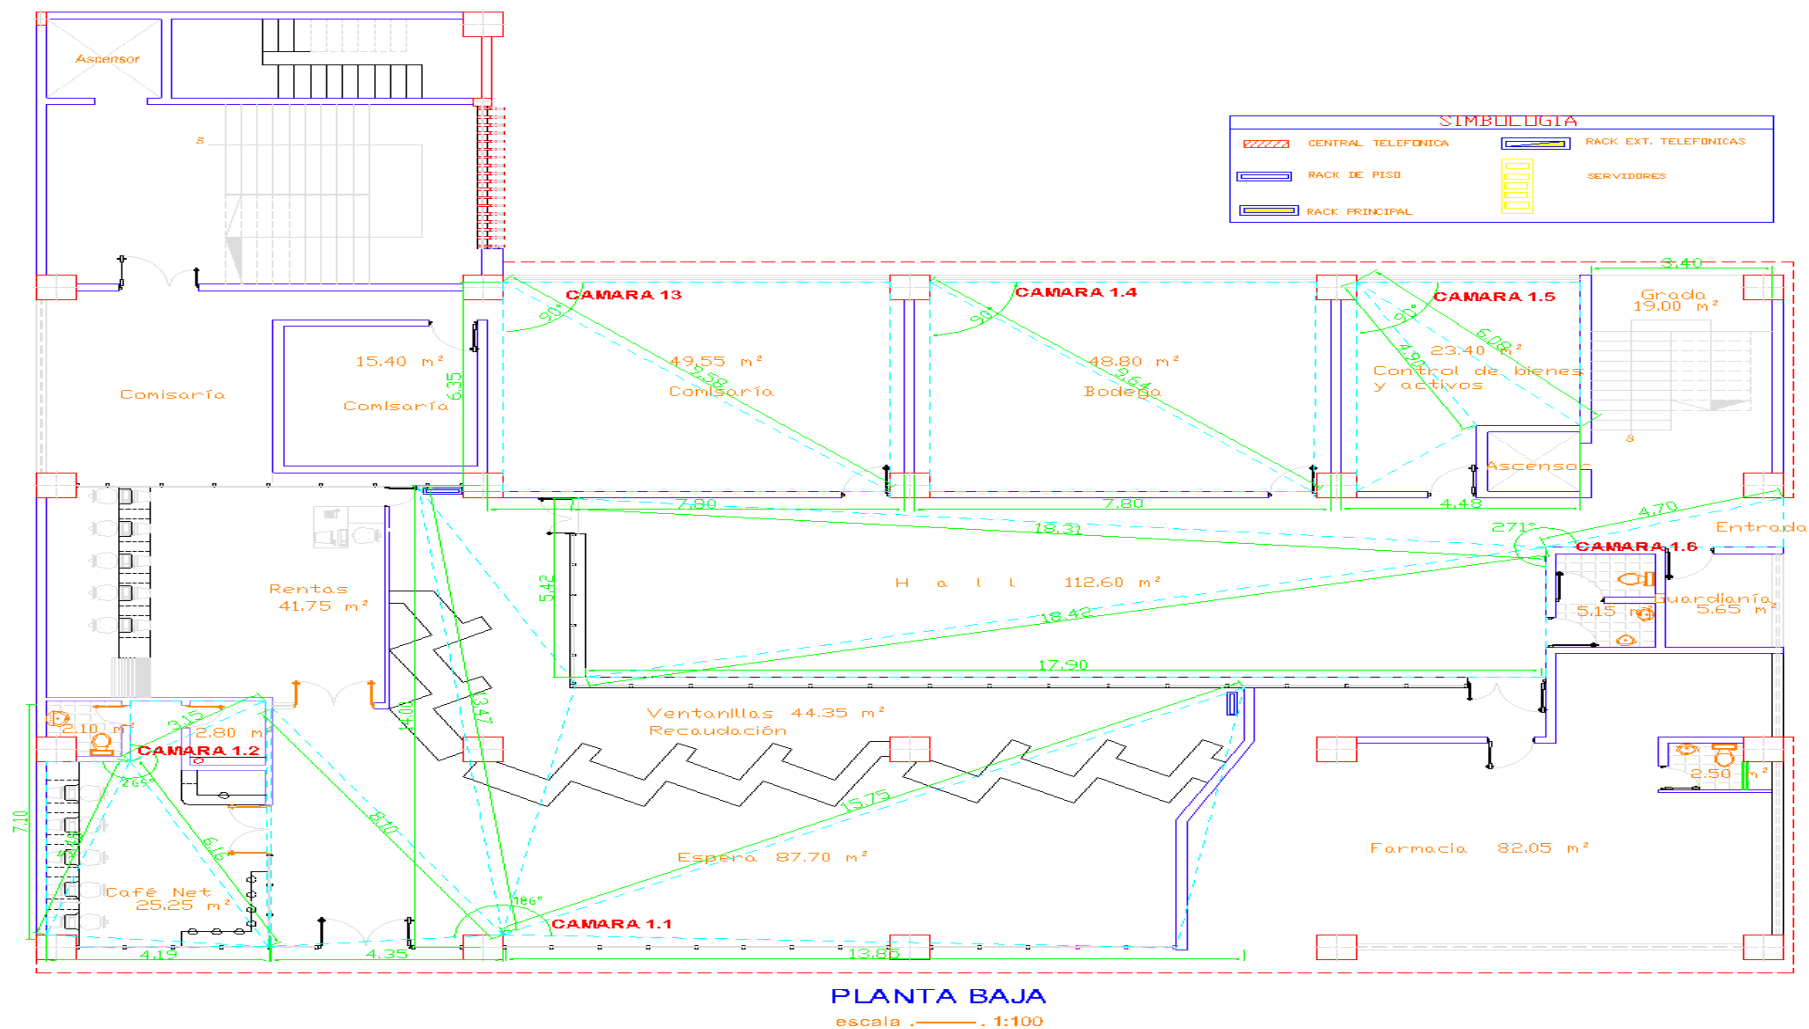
14 Ubicación de las cámaras IP en la Planta baja del GADMT
